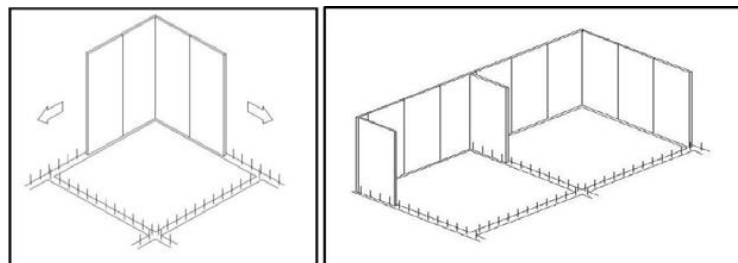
Armado de paredes colocación sucesiva de paneles.
